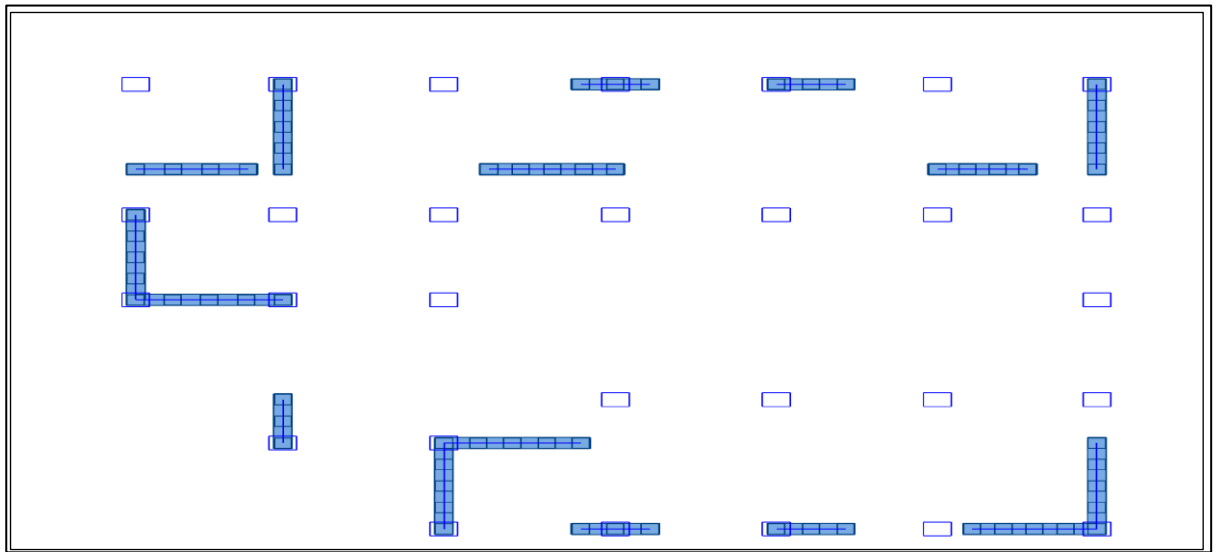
Vue en 2D et plan de la 1^{ère} proposition.
